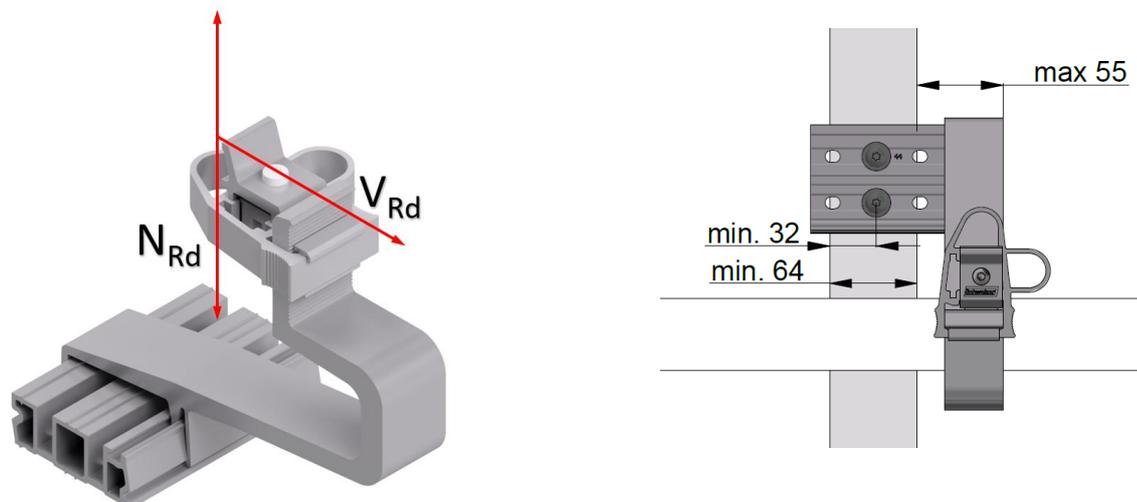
Bemessungspunkte des Dachhakens MSP-PR-RHM mit Grundplatte und Positionsverhältnissen auf dem Sparren
